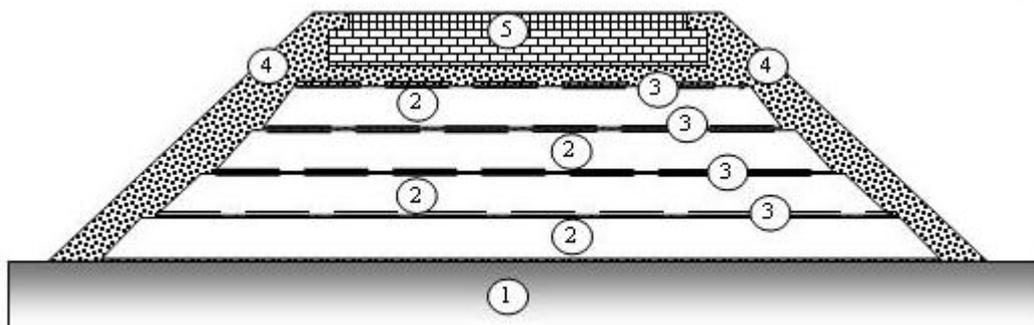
Конструкция плавающей насыпи: 1 – слабое грунтовое основание; 2 – слои вспененного полимерного материала; 3 – армирующий геосинтетический материал; 4 – минеральный грунт; 5 – дорожная одежда с укрепленным основанием
